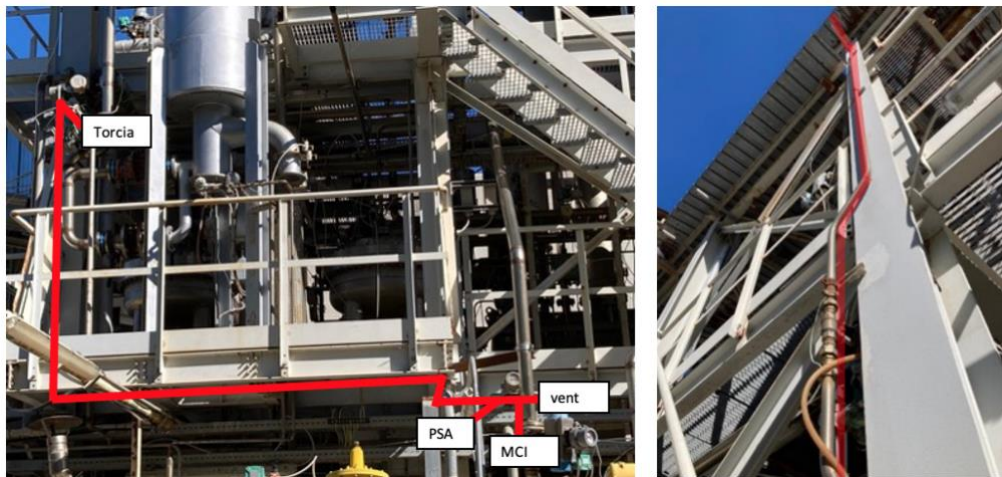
tubazione da PSA a vent, MCI, torcia (sezione esterna, vista ovest) e vent.
